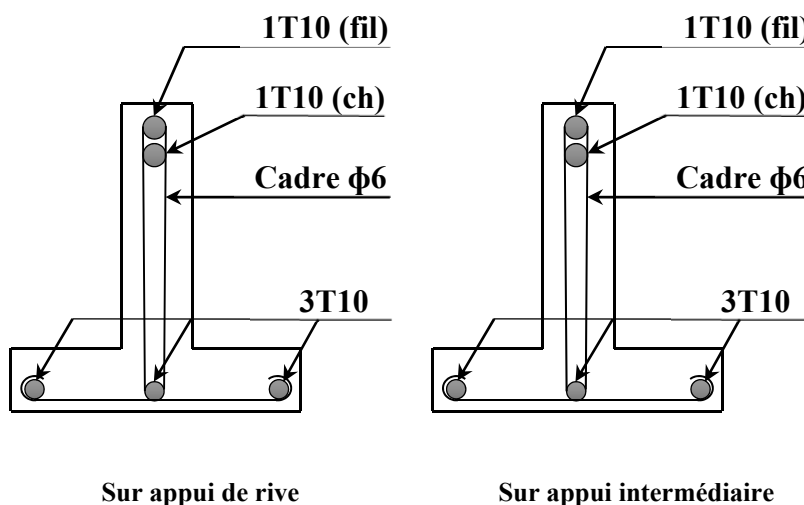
Dessin de ferrailage des poutrelles des étages courants
